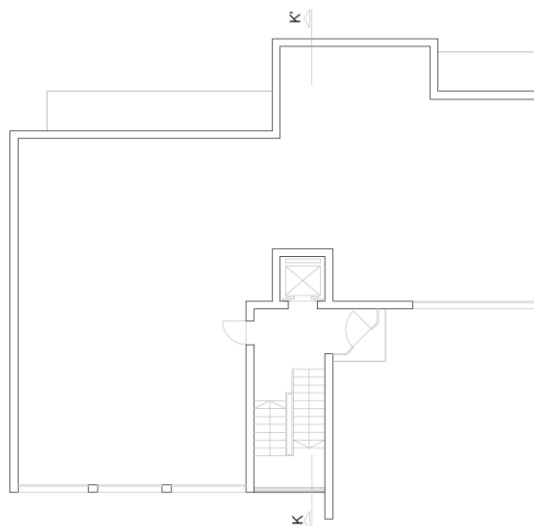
planta do Piso 0 (hall de entrada e garagens)
